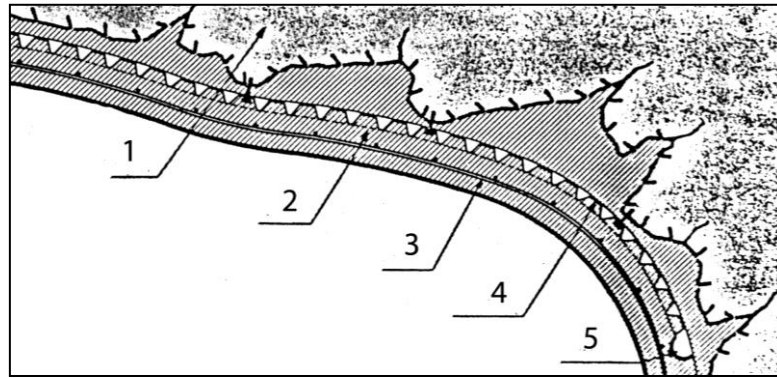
Поперечний переріз торкрет бетонного покриття з використанням в якості водовідводу «дренажної» фольги і жолобів. 1 – скала; 2- торкретбетон; 3 – арматурна сітка; 4 – «дренажна» фольга; 5 – жолоб
